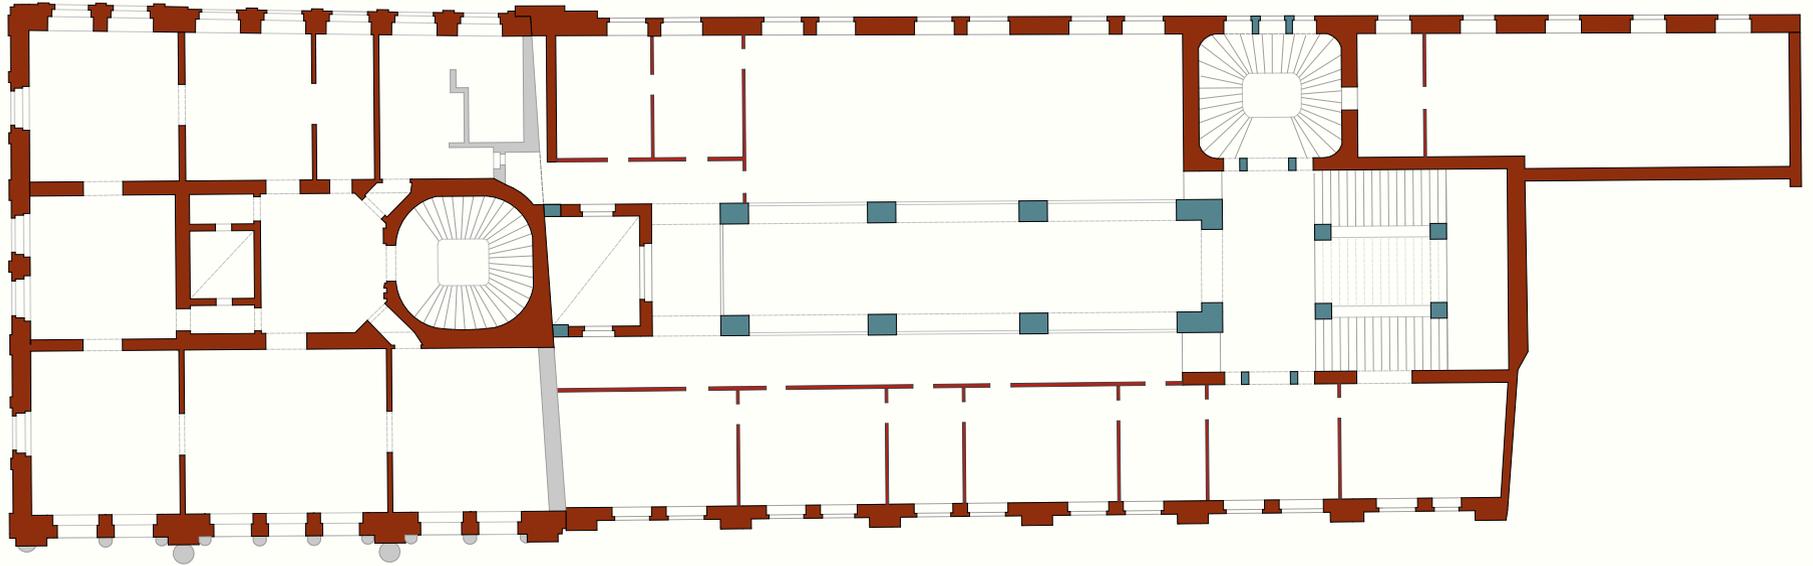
Haus am Hof inkl. Zubau, Grundriss 1. Stock
